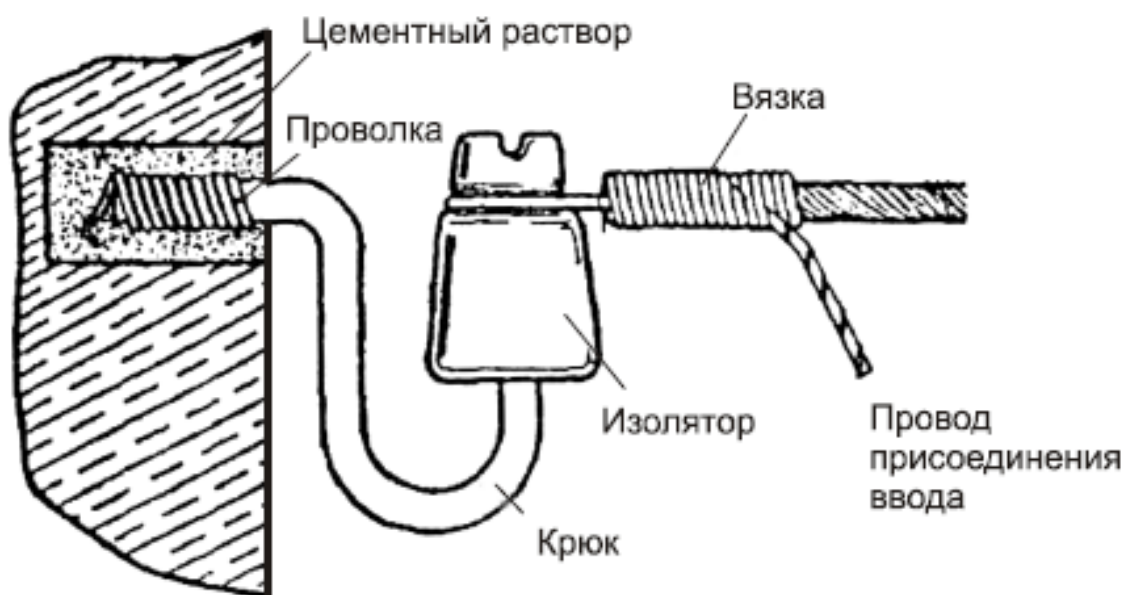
Крепление фарфорового изолятора к бетонной стене дома
